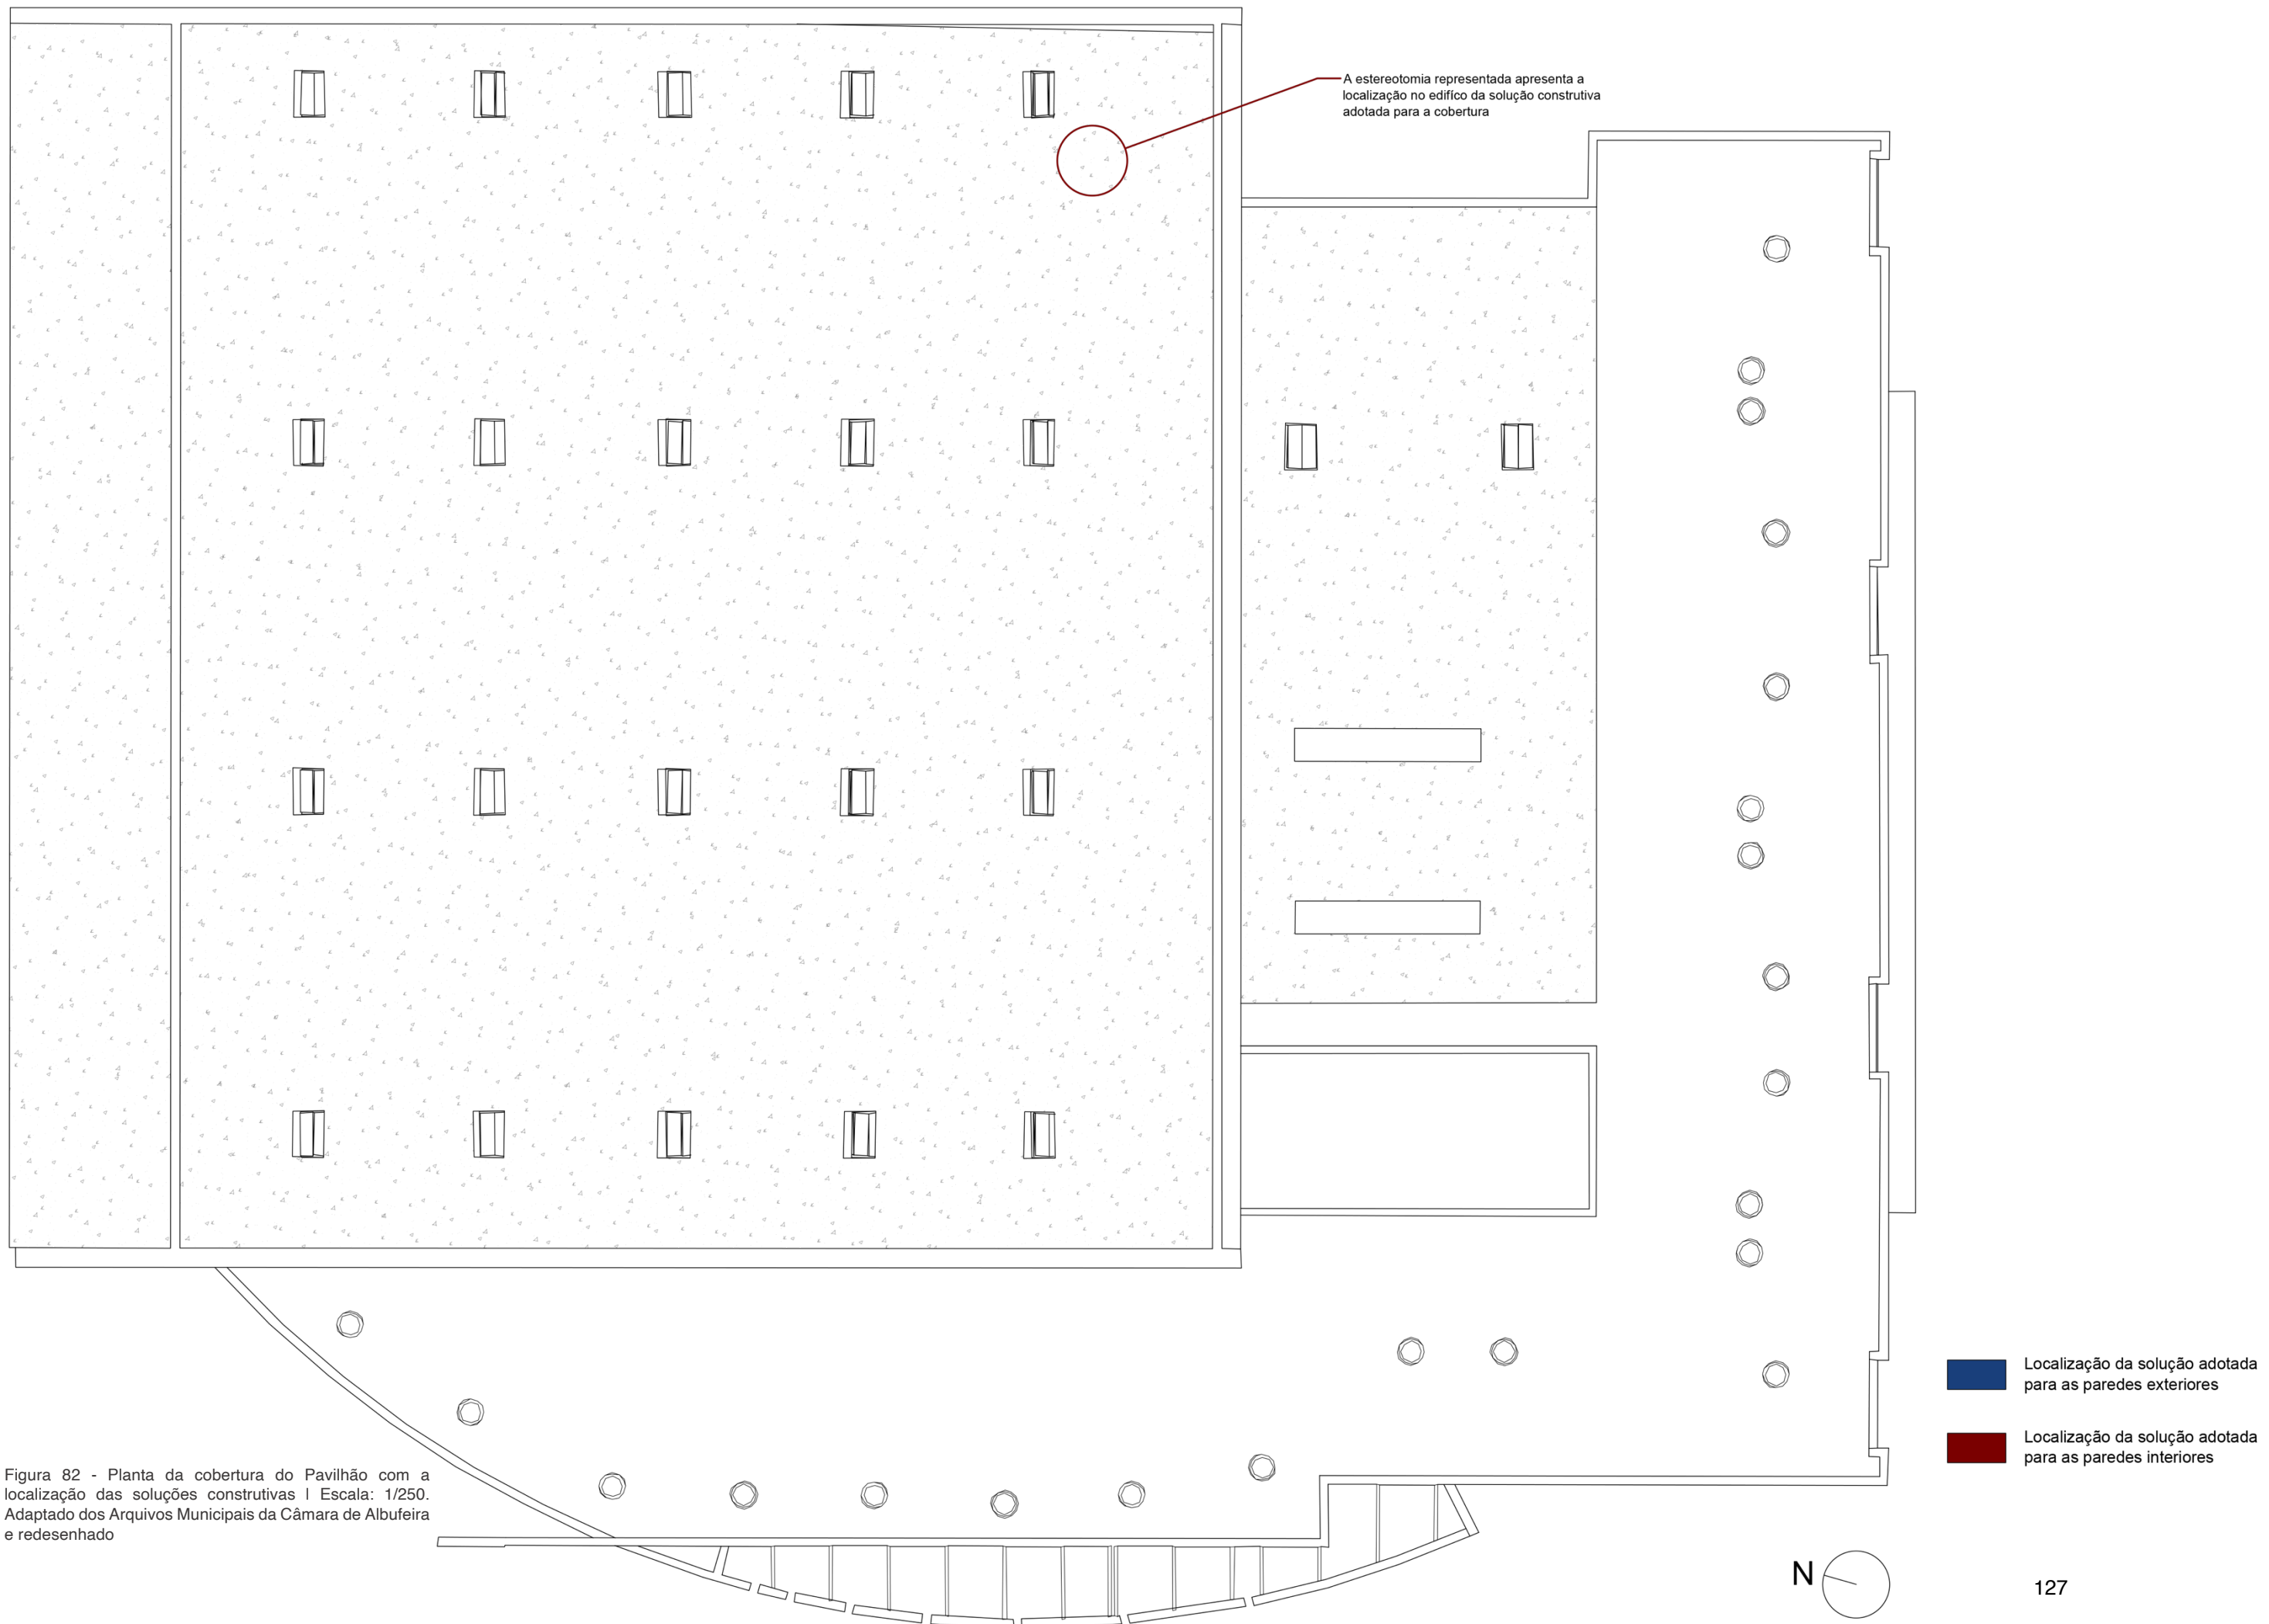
Planta da cobertura do Pavilhão com a localização das soluções construtivas | Escala: 1/250. Adaptado dos Arquivos Municipais da Câmara de Albufeira e redesenhado
